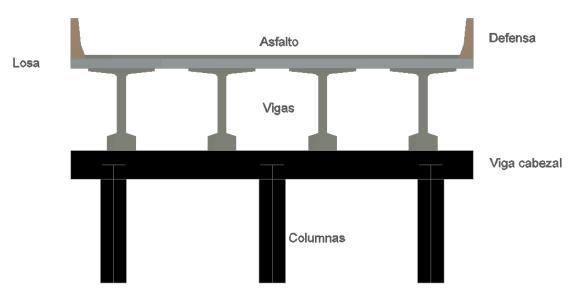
SECCION TRANSVERSAL DEL PUENTE
